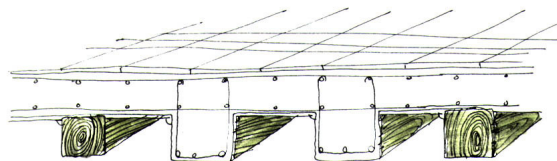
Introdução de vigas de betão armado no reforço de pavimentos de madeira
